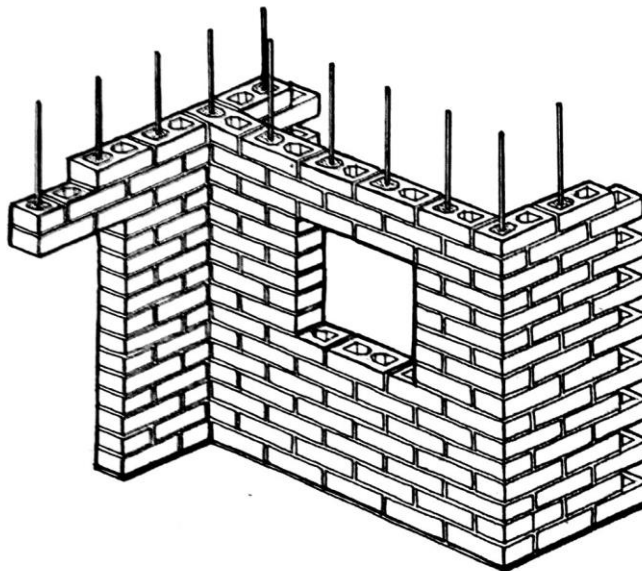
Esquema estructural de la mampostería reforzada. Adaptado de Maldonado Rondón y Chío Cho (2007). Visión estructural de las edificaciones de la ciudad de Bucaramanga.
